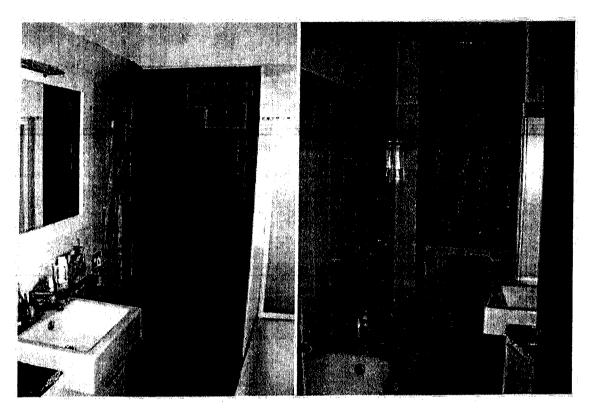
e 30 - Rilievo interno - Il locale bagno ad Ovest
